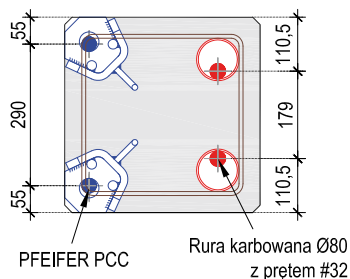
Rektyfikacja i zalewanie zaprawą słupa prefabrykowanego
